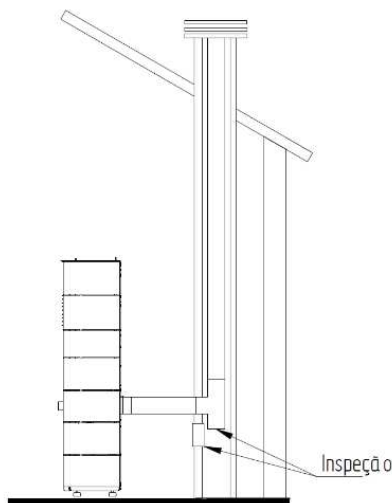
Vista lateral da instalação com chaminé, com exemplo do ponto de inspeção
